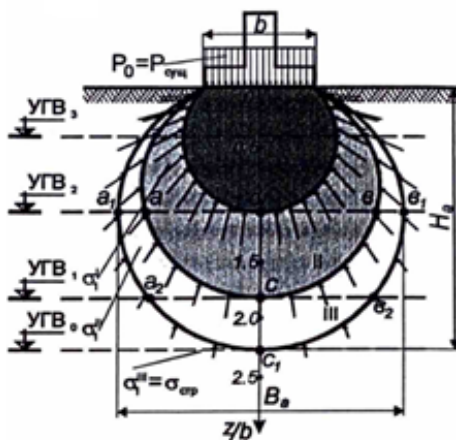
Расчет осадки фундамента, подверженного ранее уплотненным грунтам оснований
